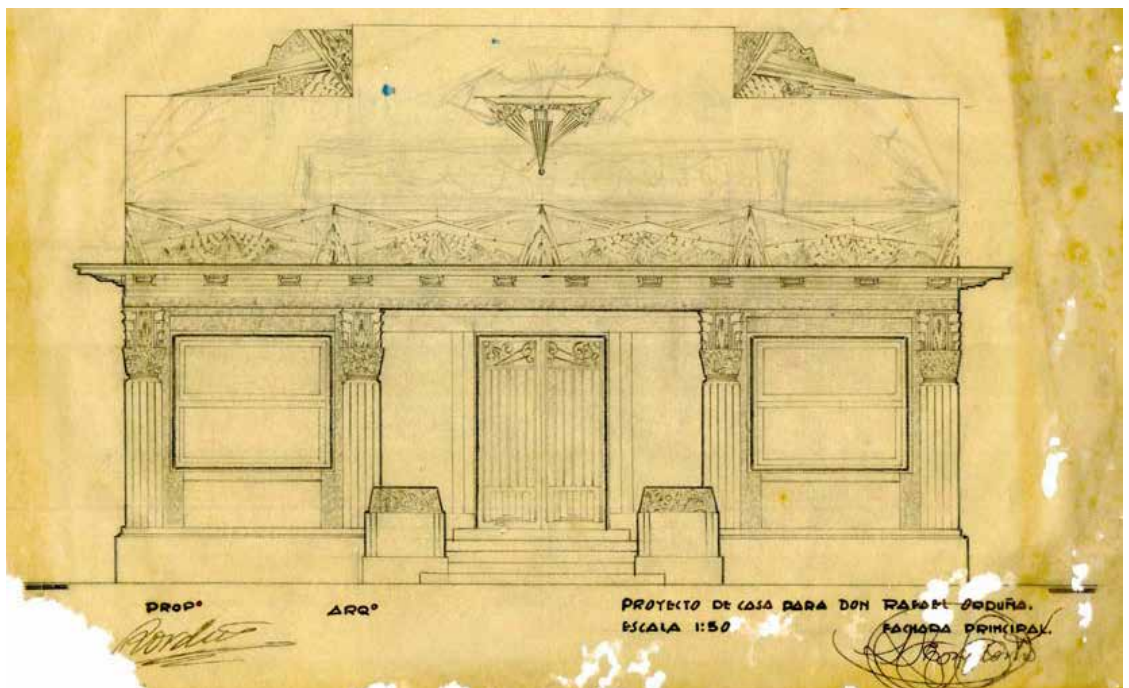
Alzado principal. Proyecto de Casa para Don Ramón Orduña. Lorenzo Ros Costa.
